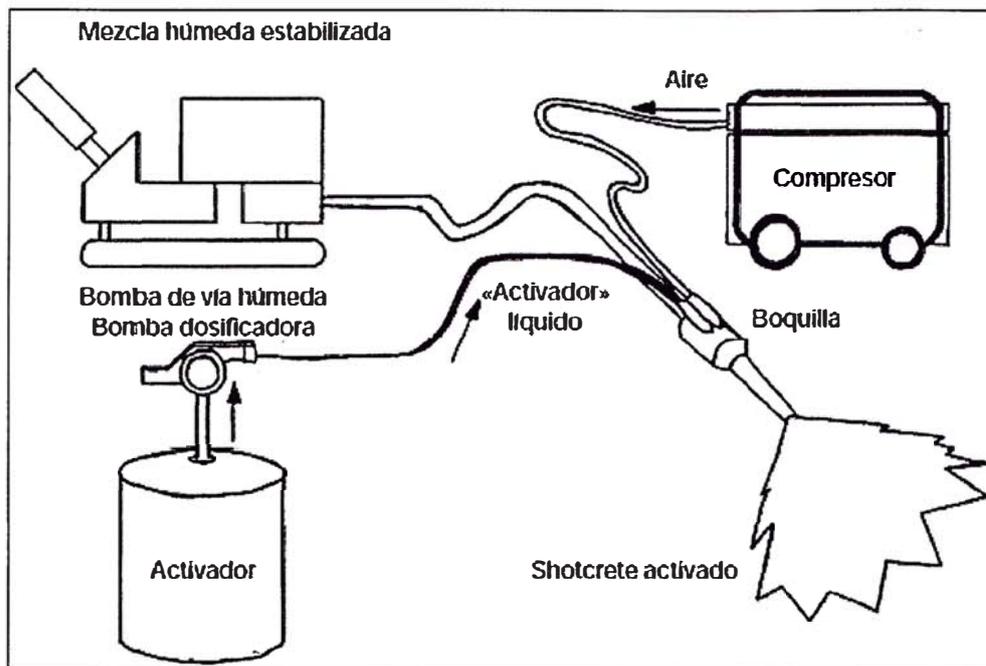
Esquema del Concreto Proyectado por vía húmeda.
